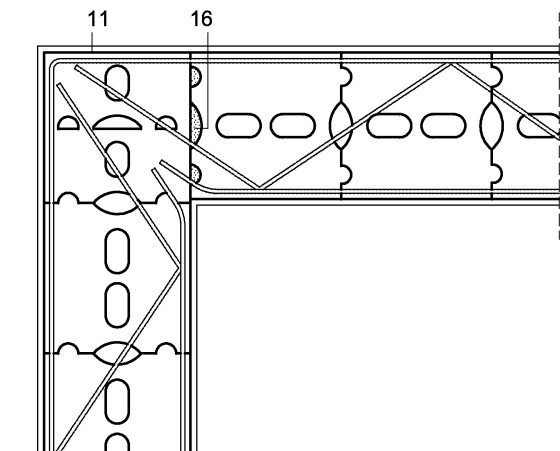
Encuentro en esquina hilada impar. Muro portante. Bloque de longitud 30.
